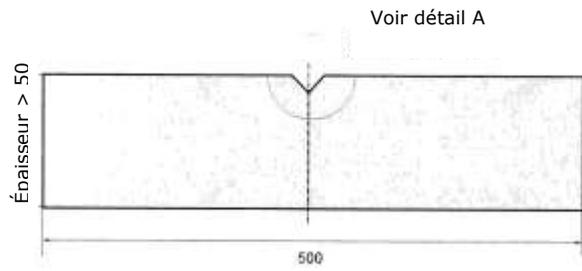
Sto-Panneaux pour Bossage Type III (dimensions en mm)
